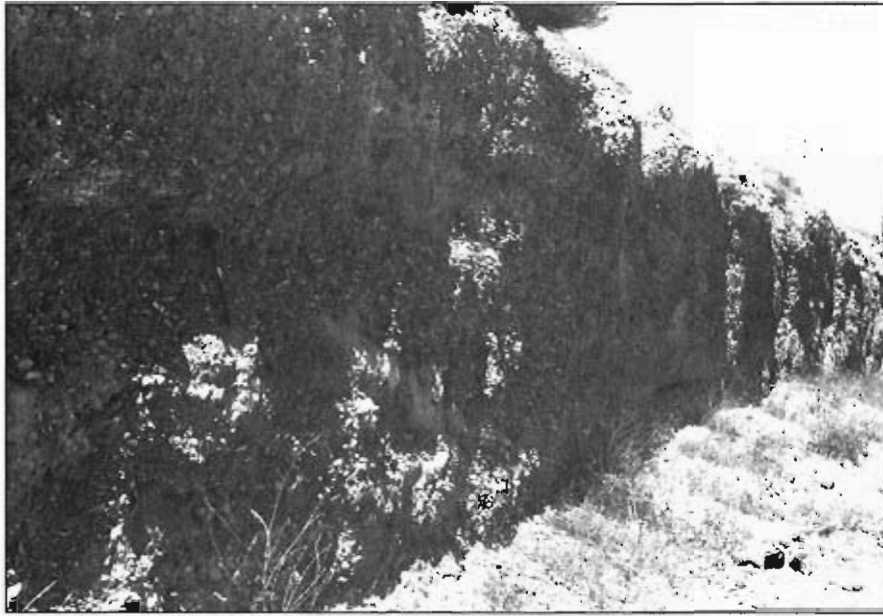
Talud de excavación subvertical de unos 4 m de altura en el grupo 350b.
